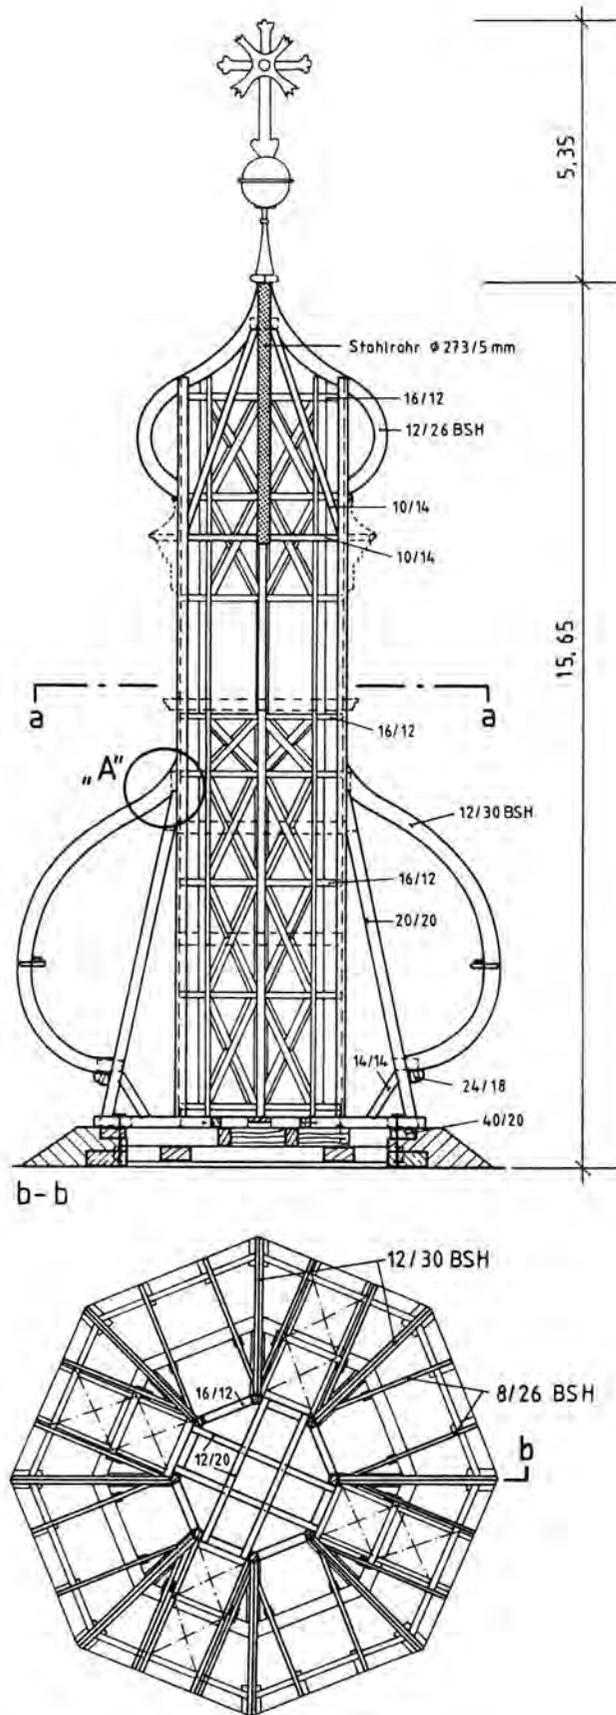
Wallfahrtskirche Eichlberg, Querschnitt und Grundriss der Turmkuppel, aus /61/
